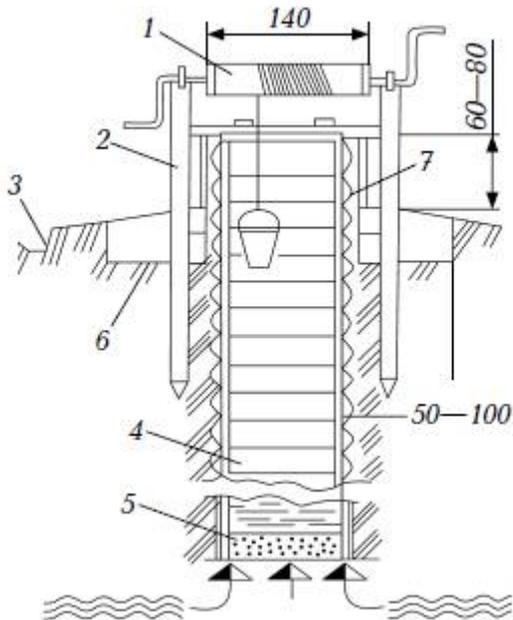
Внутреннее устройство шахтного колодца: 1) ворот; 2) спайка; 3) водоотводная труба; 4) сруб; 5) слой гравия; 6) глиняный замок; 7) дощатая обшивка оголовка
